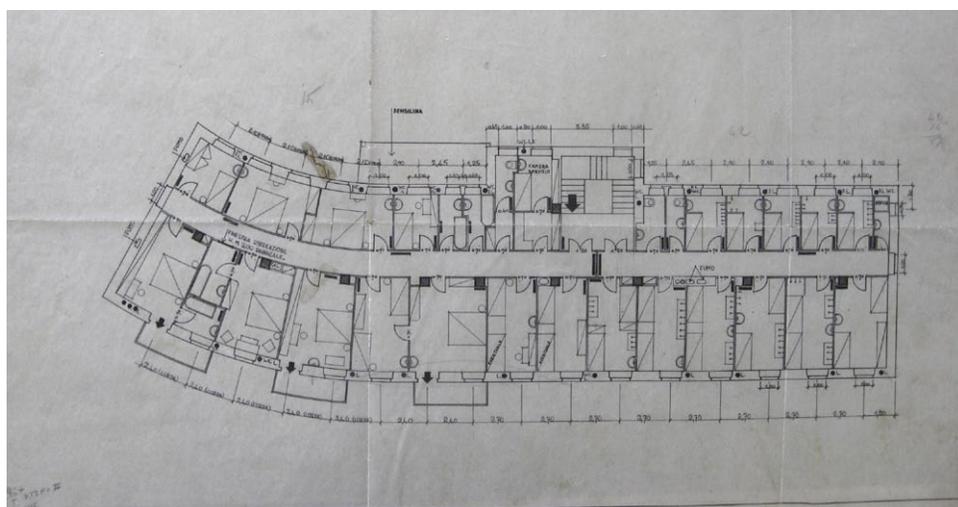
Grundriss 2.OG, 01.08.1935
